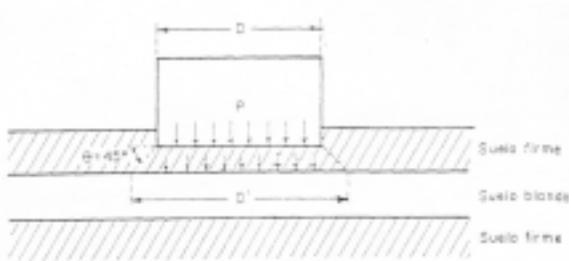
I CIMENTACION DESPLANTADA SOBRE UN ESTRATO BLANDO CONFINADO.
